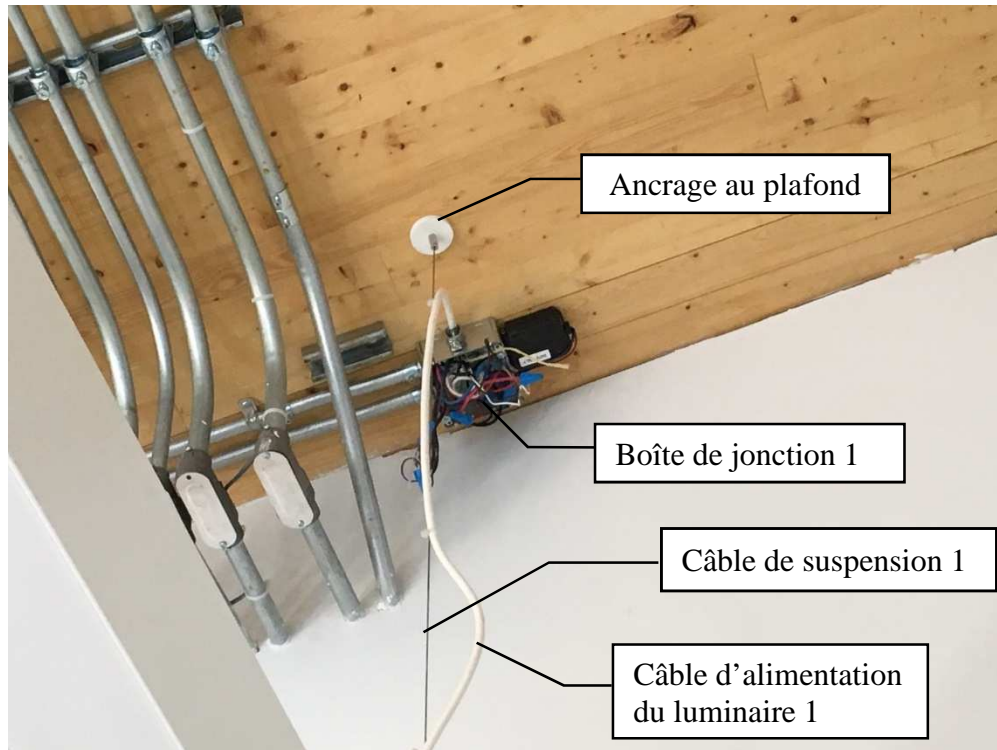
Ancre et câble métallique de suspension du luminaire 1
